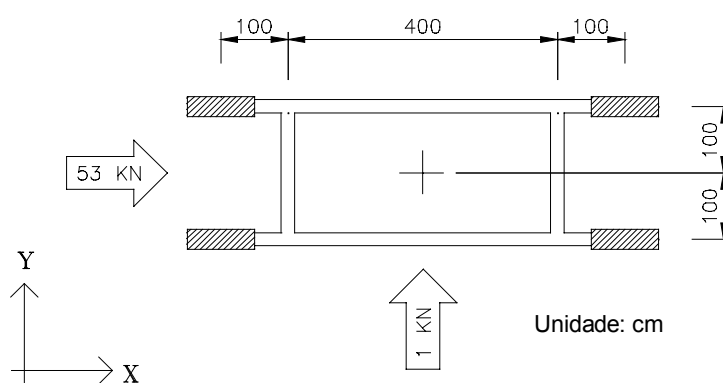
Estrutura com ligação viga-viga nas proximidades de pilares - caso 01
